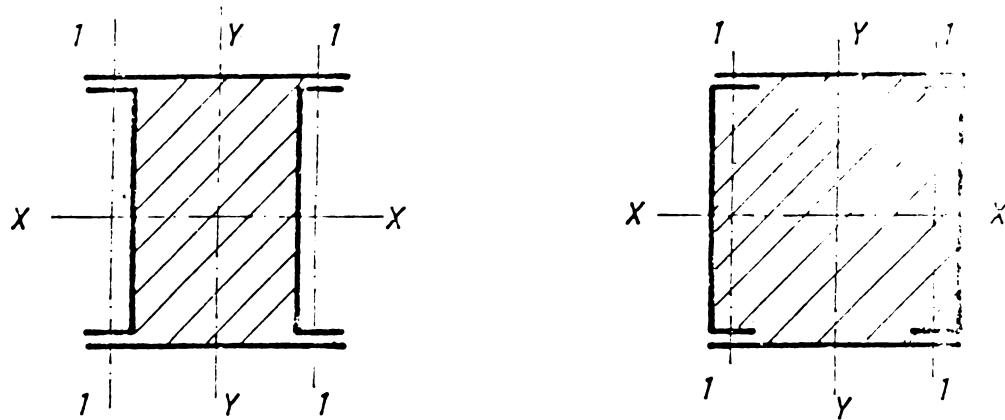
SECTIUNI DE STILPI DIN OTEL BETON
